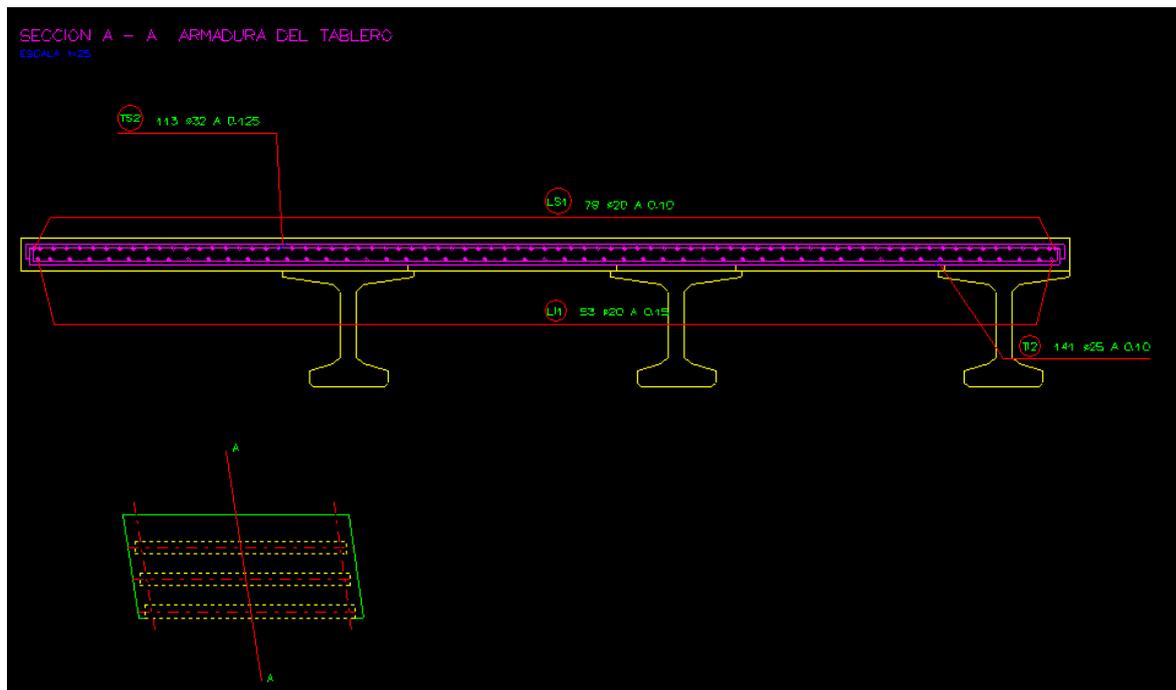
Figura *Losa. Sección transversal*.
